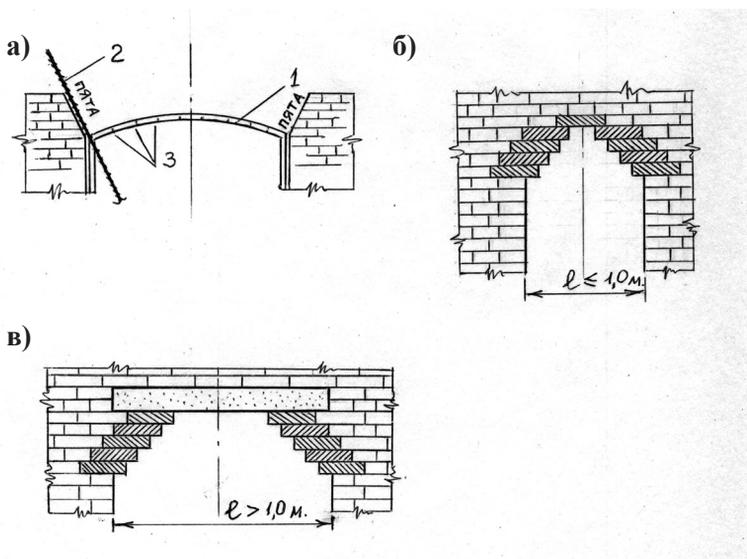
Варианты безкружальных перемычек: а) определение наклона пьест для лучковой арки; б) кладка безкружальной перемычки; в) комбинированная перемычка.
